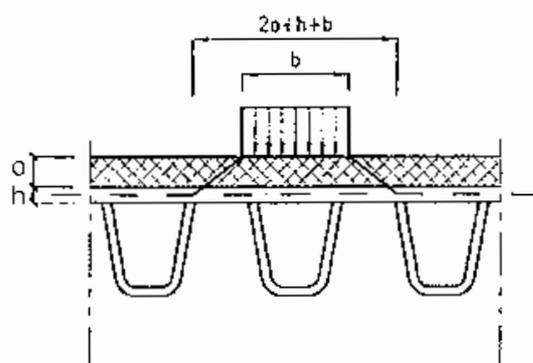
Diffusione dei carichi concentrati attraverso la pavimentazione e gli impalcati a piastra ortotropa
